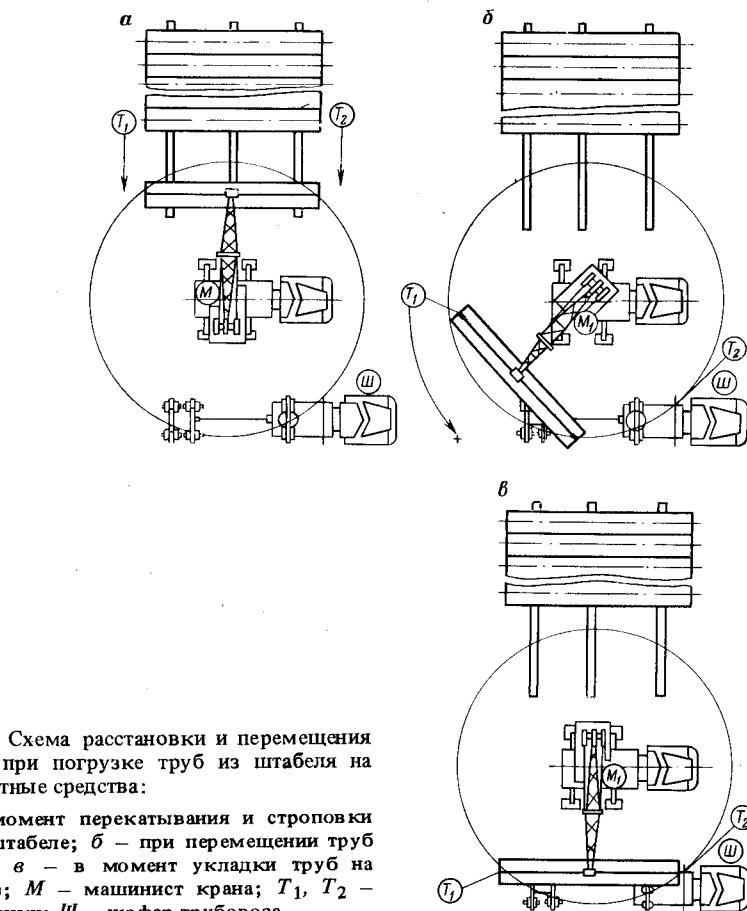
Схема расстановки и перемещения рабочих при погрузке труб из штабеля на транспортные средства:
